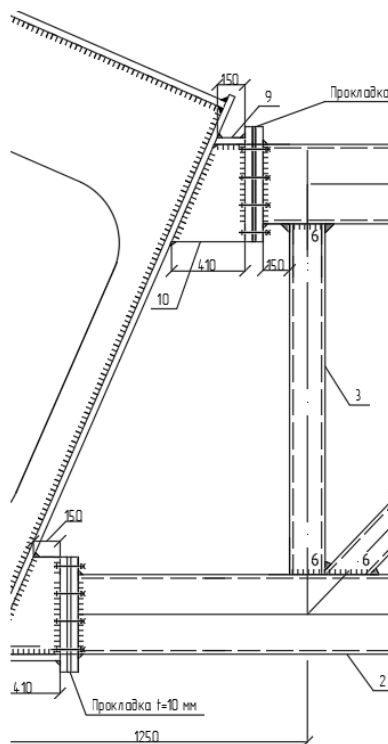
Узел крепления поясов фермы к стенке арки
